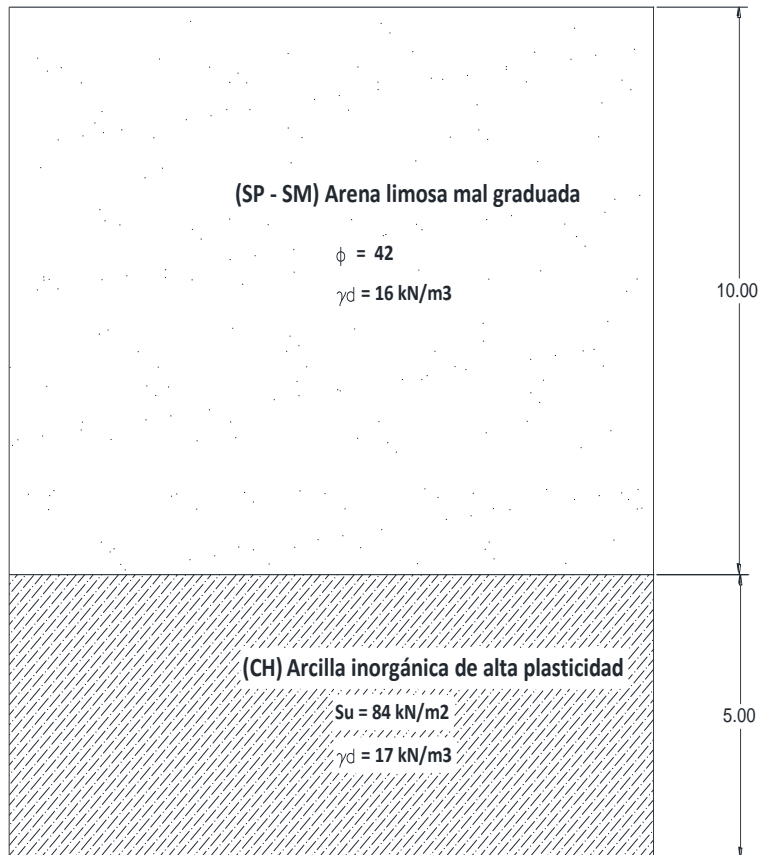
Perfil longitudinal simplificado (fuente: elaboración propia).
